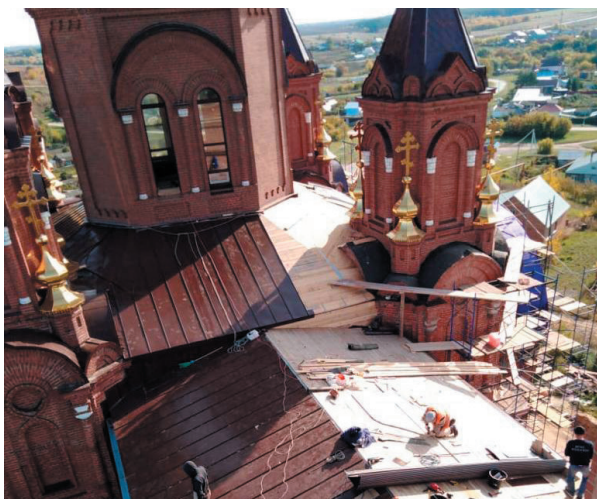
Монтаж стропильных конструкций и утепление кровли; монтаж металлического фальцевого покрытия кровли
